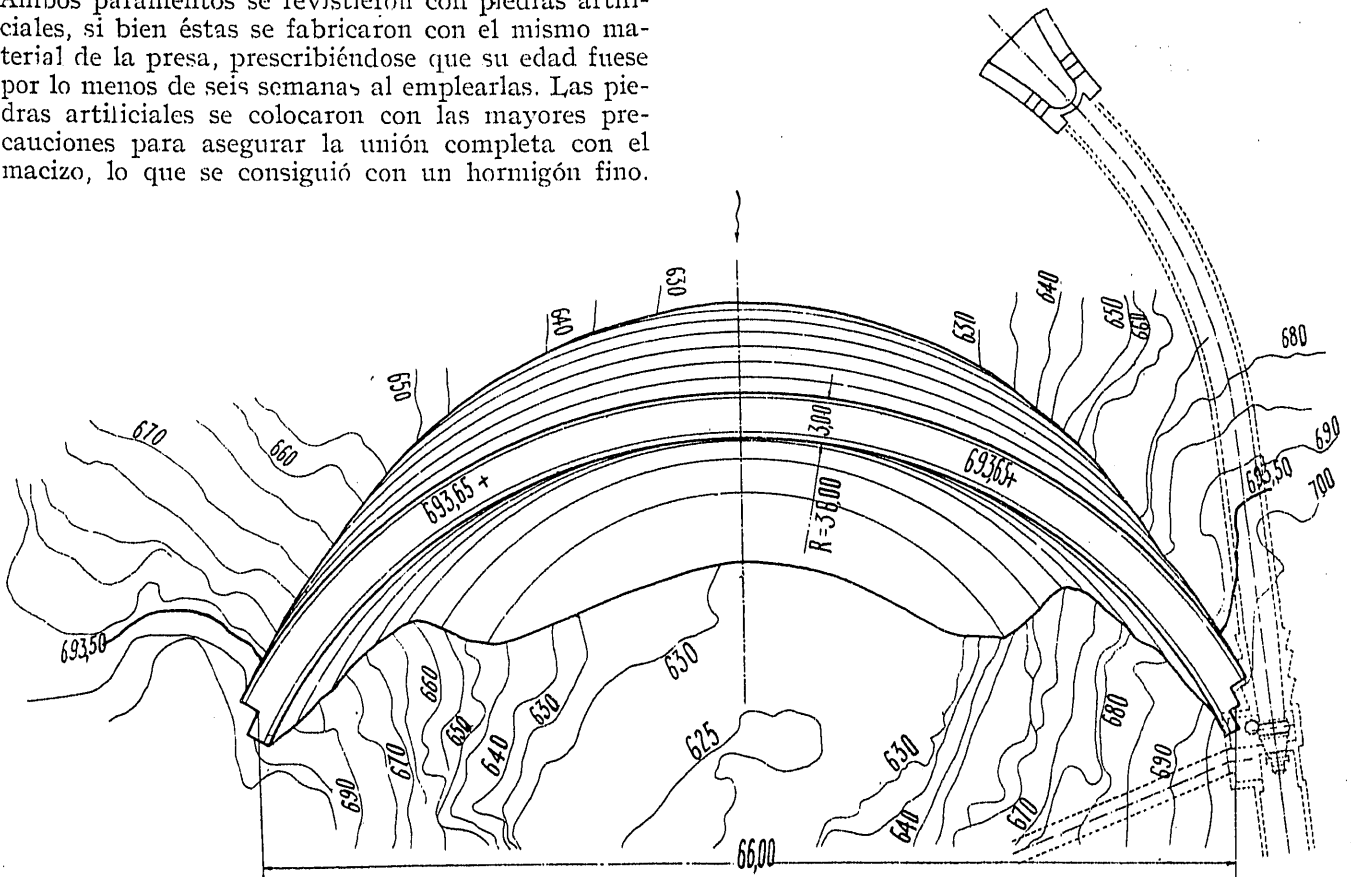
º a. Plano de la presa-bóveda de Montejaque.
